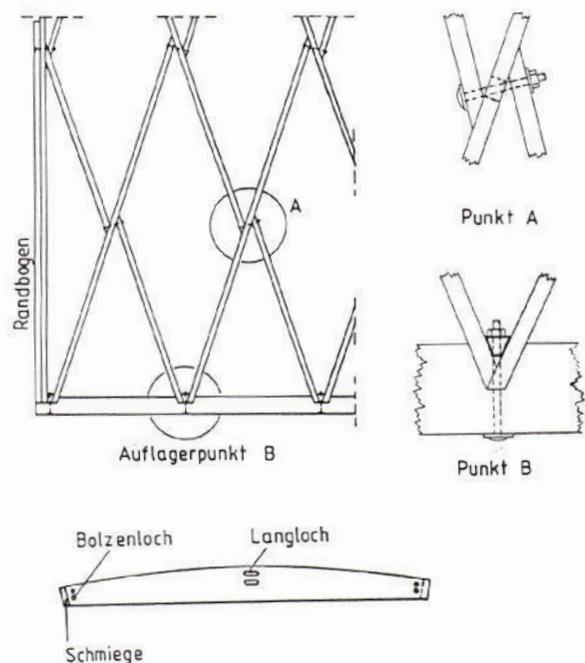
Konstruktionsprinzip des Zollinger-Lamellendaches
